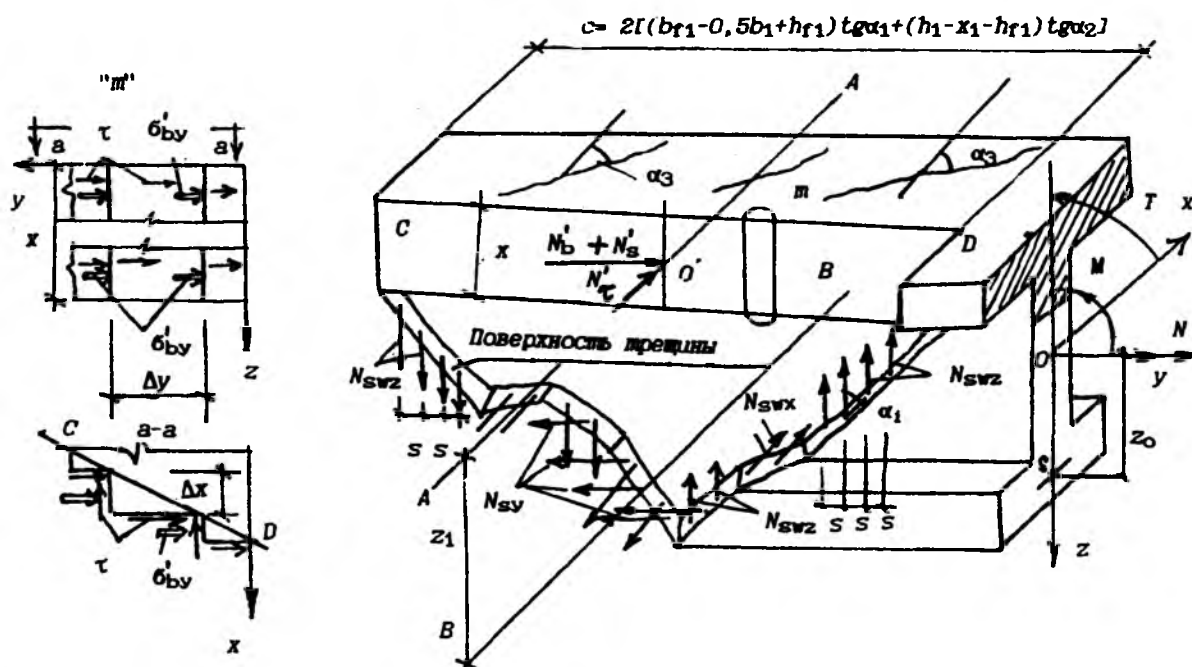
Схема пространственного сечения для определения напряжений в арматуре и бетоне элемента двутаврового профиля
